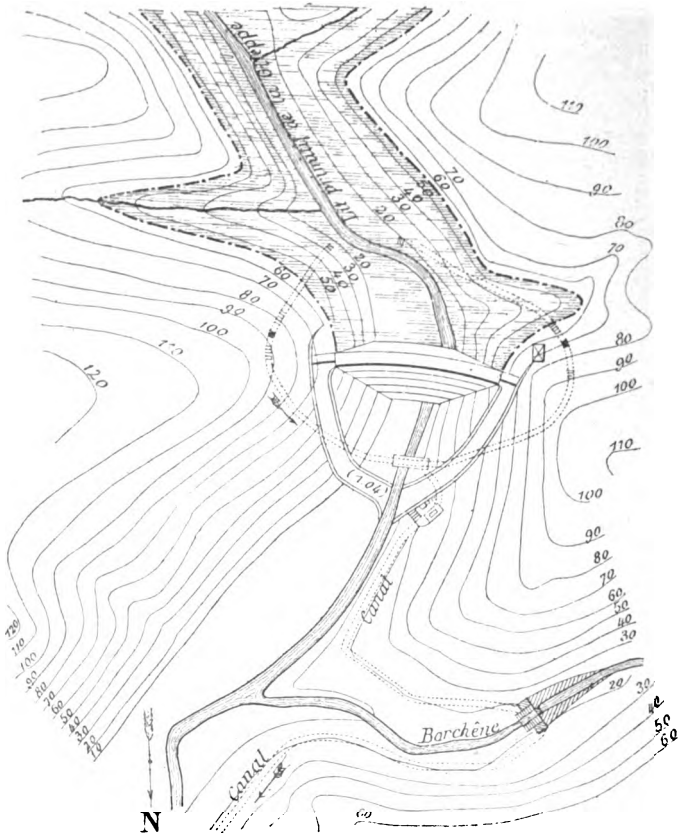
Plan du barrage de la Gileppe et de ses abords.
